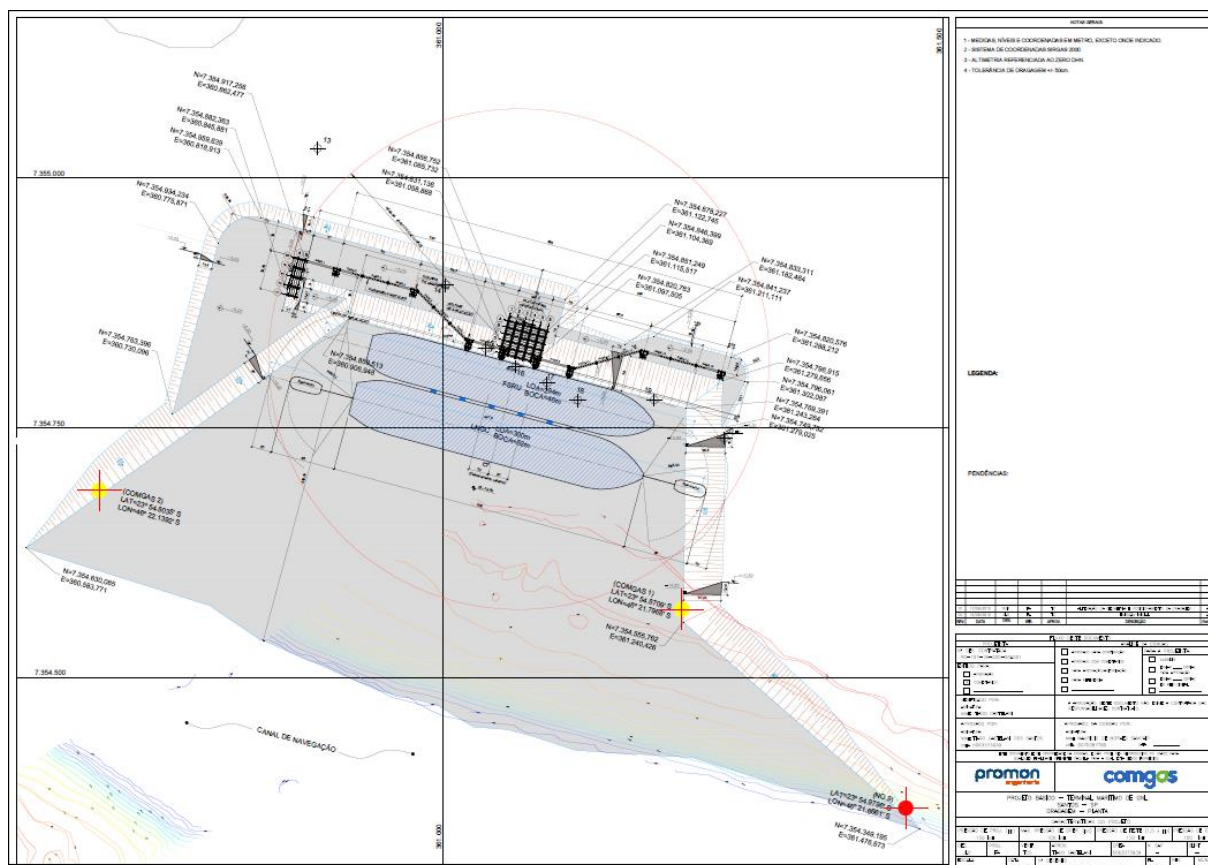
Área do empreendimento e Plano de linhas para execução da dragagem apresentado no EIA.
